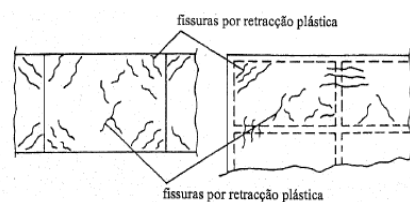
Fissuras por retração plástica em lajes e pavimentos (Coutinho, 1998)
